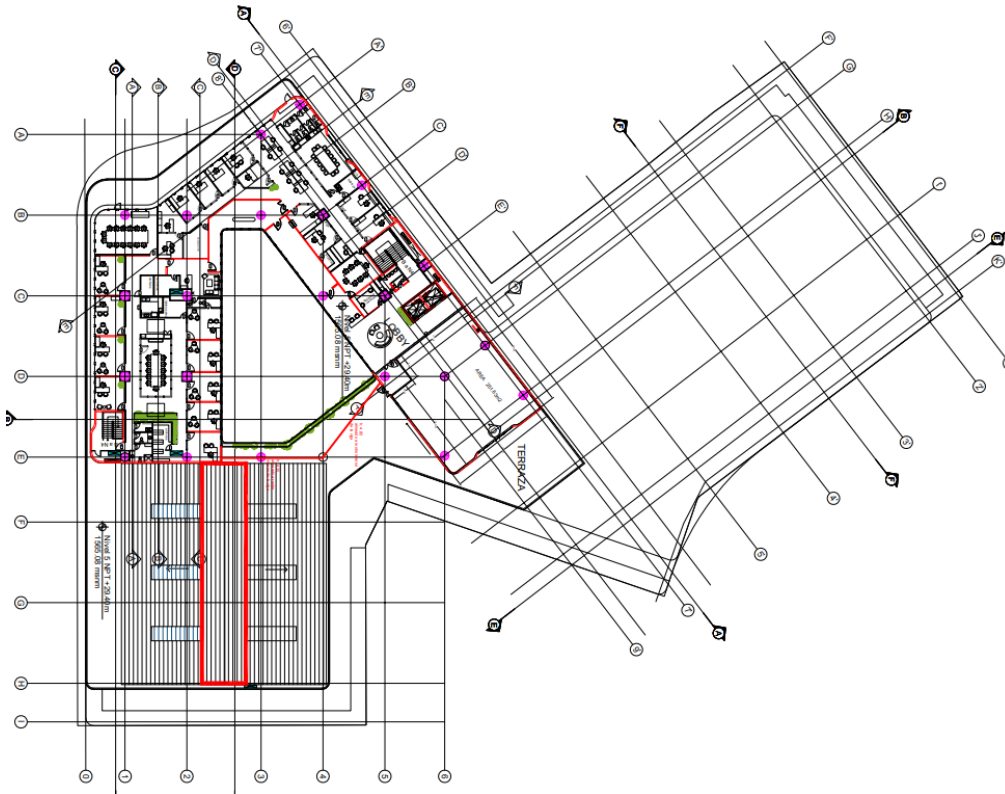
Plano de techo metálico de gimnasio en nivel 5 - área asignada para paneles solares
